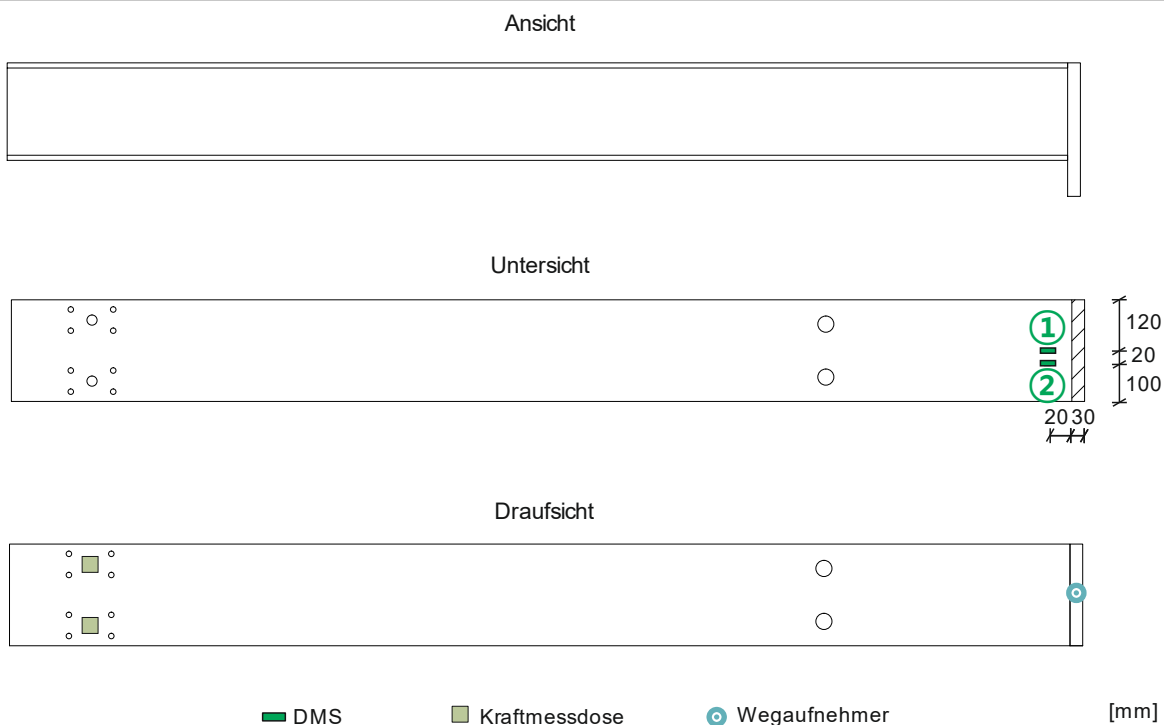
DMS der Großprobekörper in Ansicht und Draufsicht
